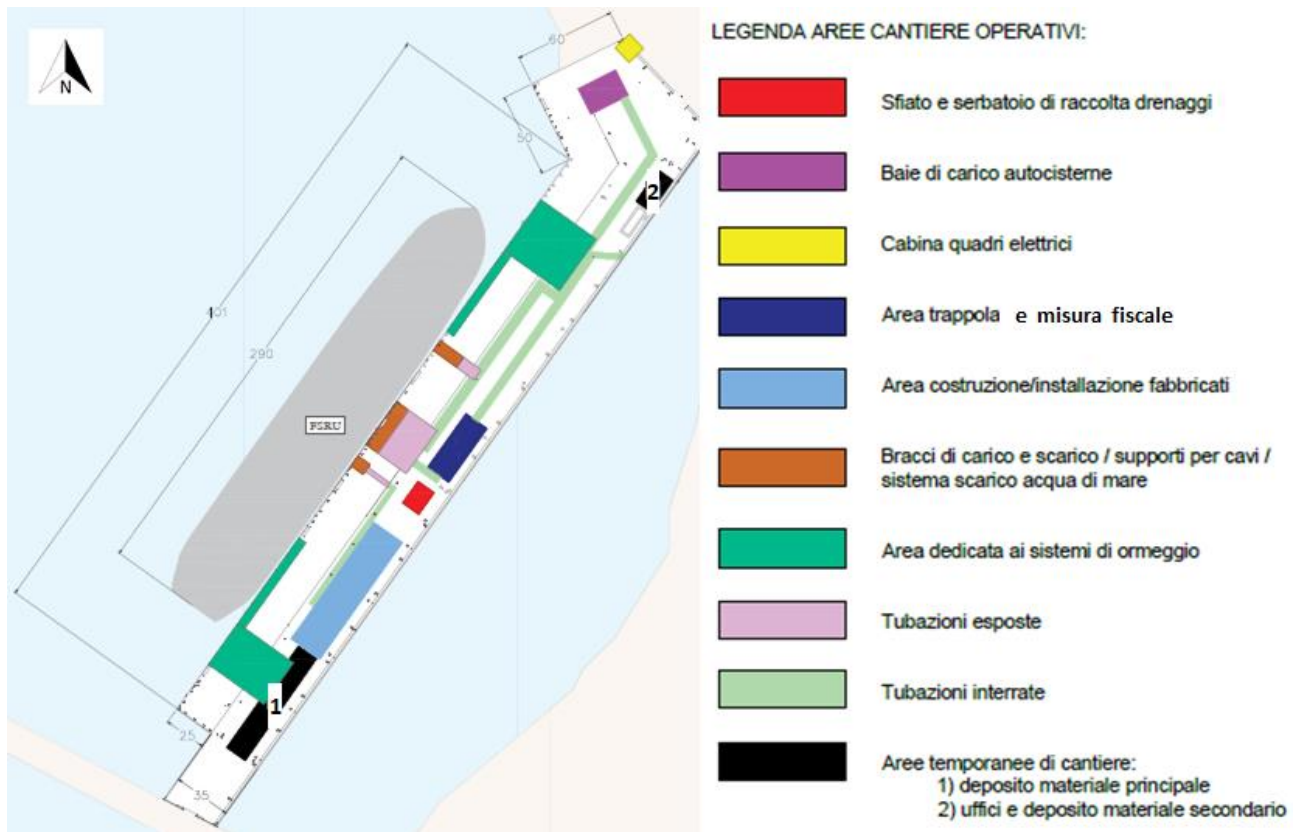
Planimetria Generale Aree Cantiere Operativi
